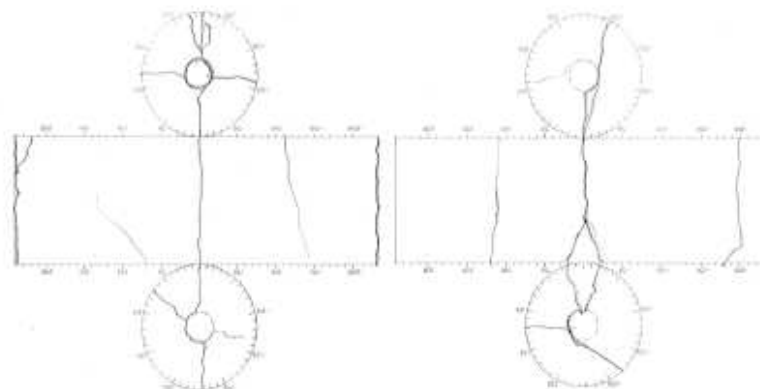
Esquema fisuración en muestras B-BCN1 (izd.) y B-BCN2 (der.)
